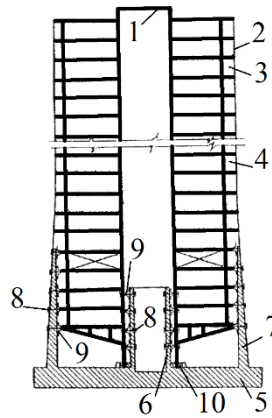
Многоэтажное сейсмостойкое здание Семенца Г.Г.: 1- полая башня; 2 – плиты перекрытия; 3 – несущие вертикальные элементы; 4 – пространственно жёсткие этажи; 5 – фундамент; 6 – внутренний контур жёсткости; 7 – наружный контур жёсткости; 8 – болты; 9 – демпферные элементы; 10 – жёсткие амортизаторы
